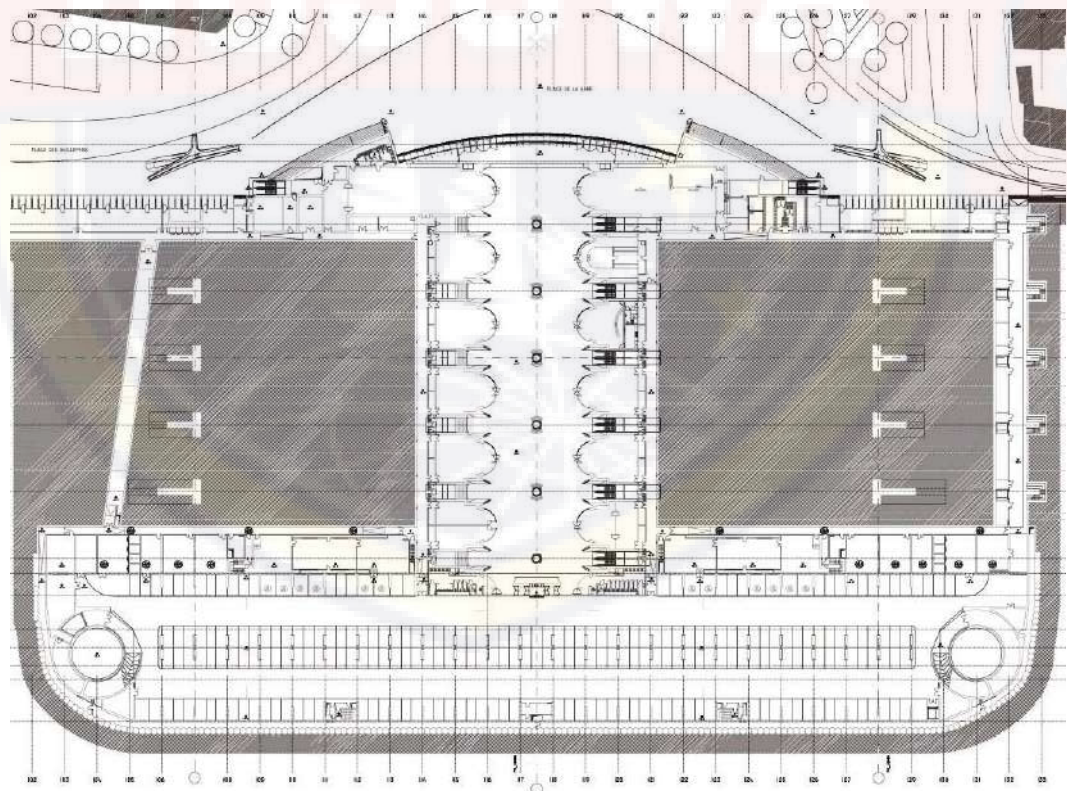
Gambar Tampak Guillemins TGV Railway Station
